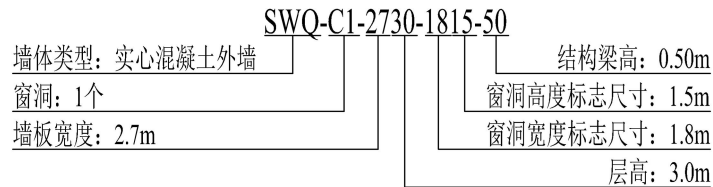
一个窗洞实心混凝土外墙编号规则示意图
